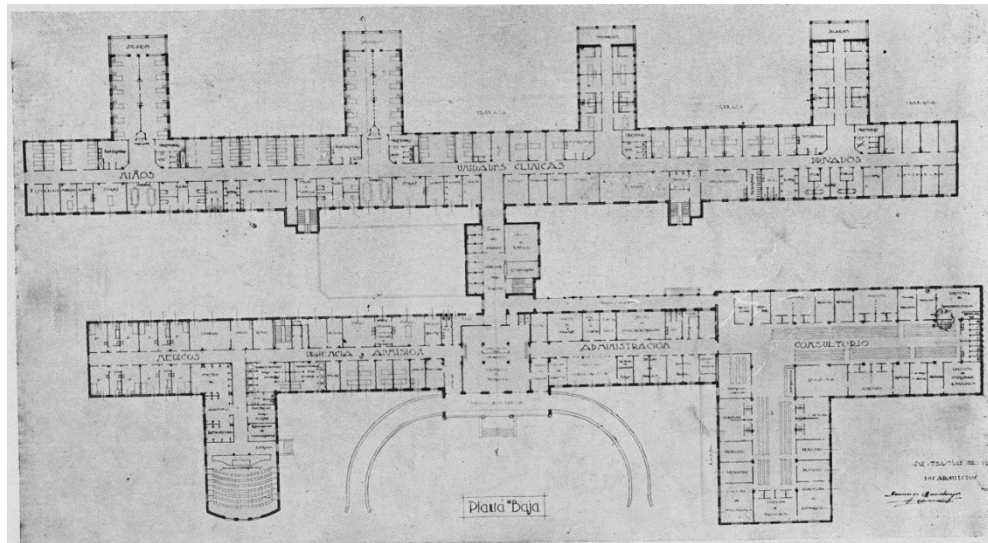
Planta baja del hospital de San Sebastián de Aguirrebengoa y Arcola.
